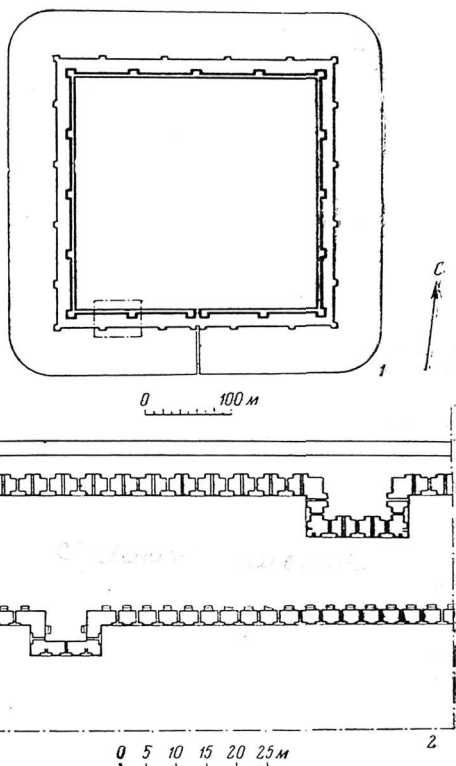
План крепости раннеантичного периода (1) и деталь плана (2). Реконструкция
